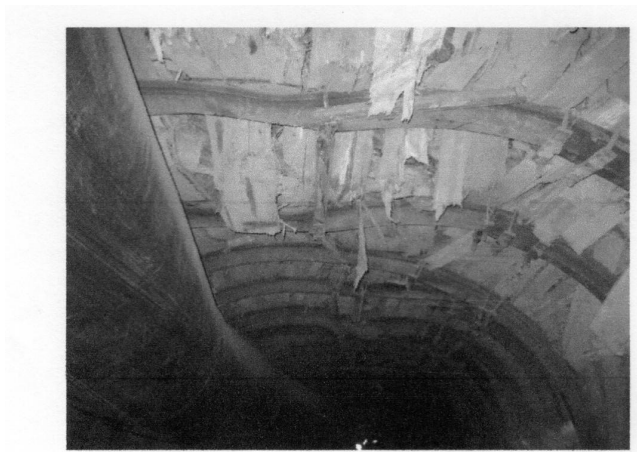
Деформирование крепи вентиляционного штрека № 3 за пределами расчетной зоны ПГД
